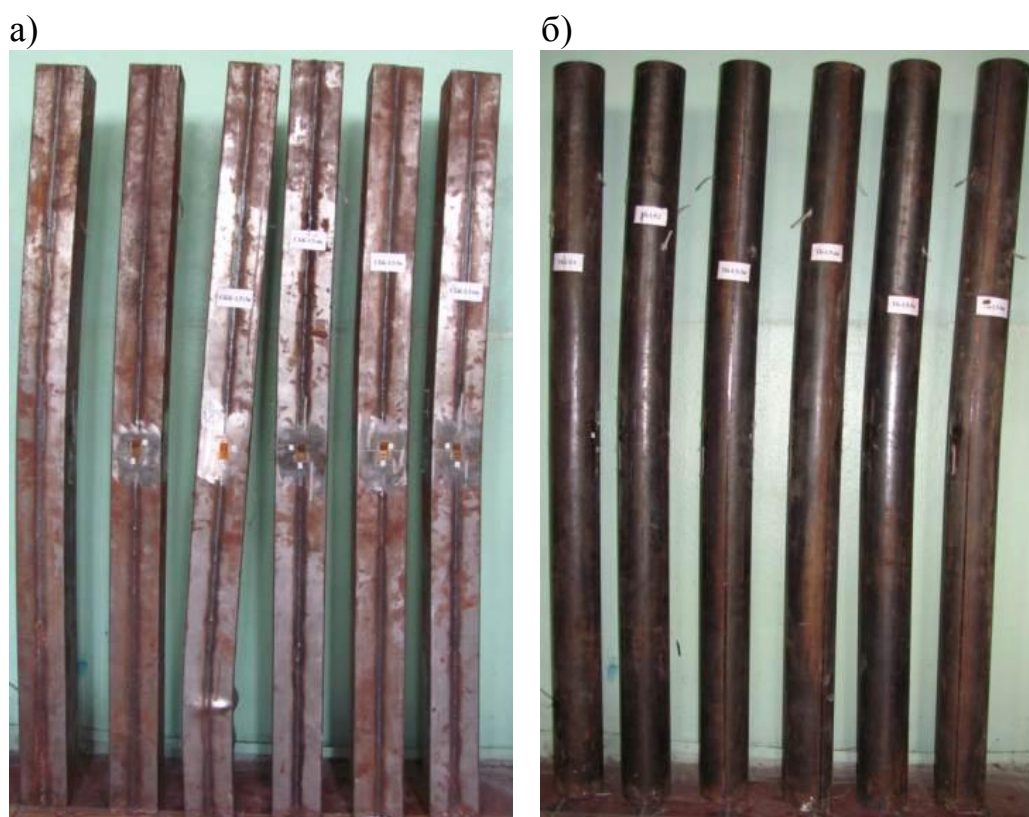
Характер руйнування гнучких сталобетонних колон квадратного (а) та круглого (б) поперечного перерізів
